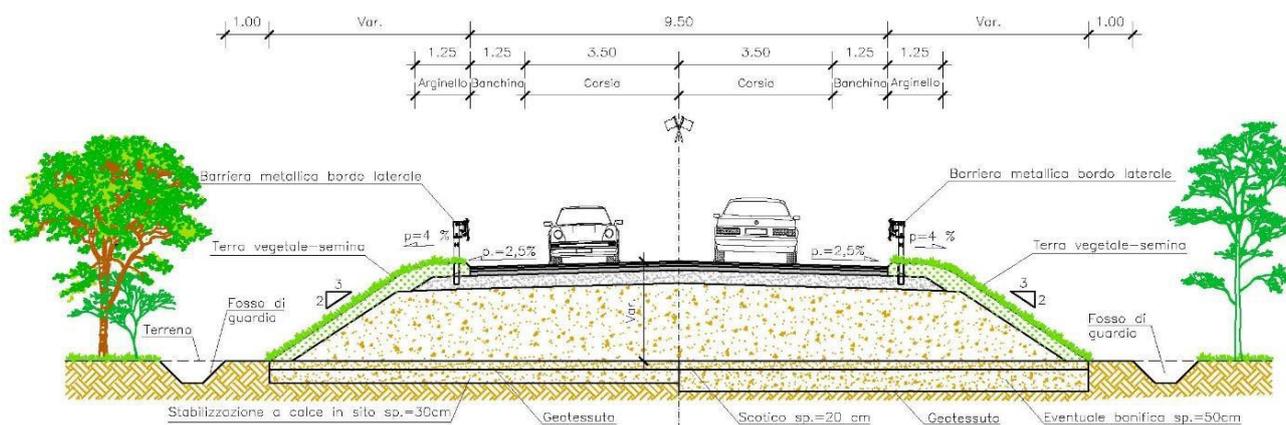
Sezione tipo C2 in rettilineo attraversamento abitato di Tai di Cadore
